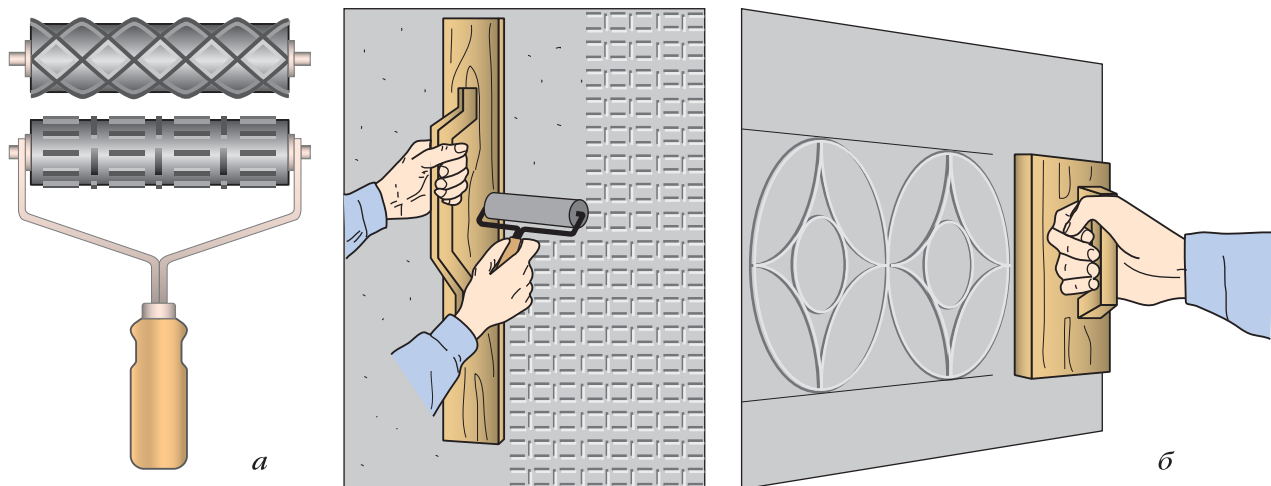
Отделка пластиковой наклейки вдавливанием: а — валиком; б — штампом
